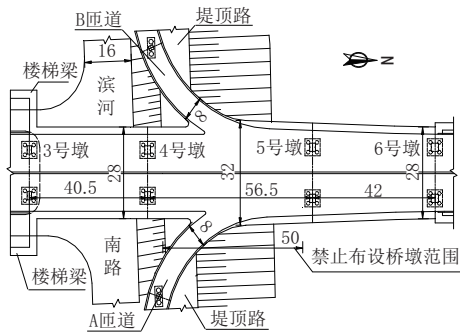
异形钢箱梁桥跨平面布置图(单位:m)
